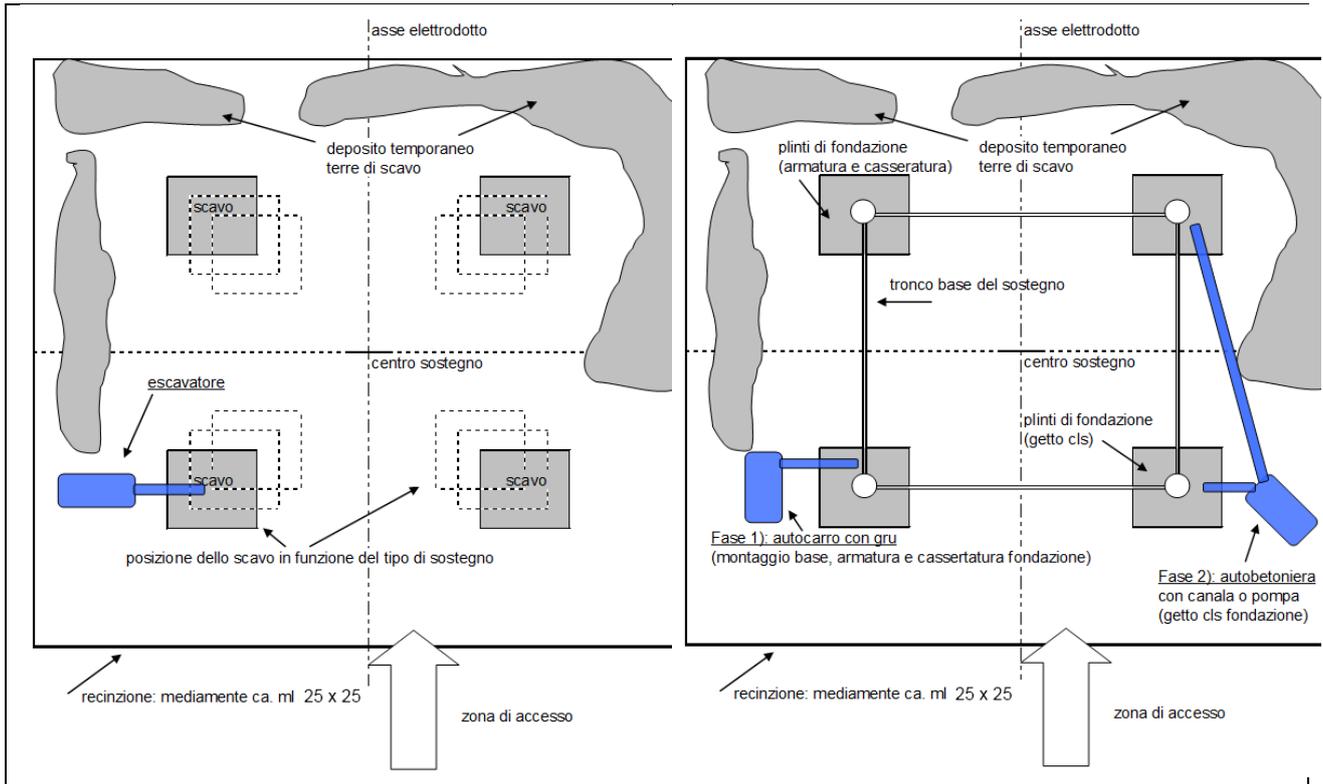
Planimetria dell'Area Sostegno (scavo di fondazione - getto e basi) - Tipologico
